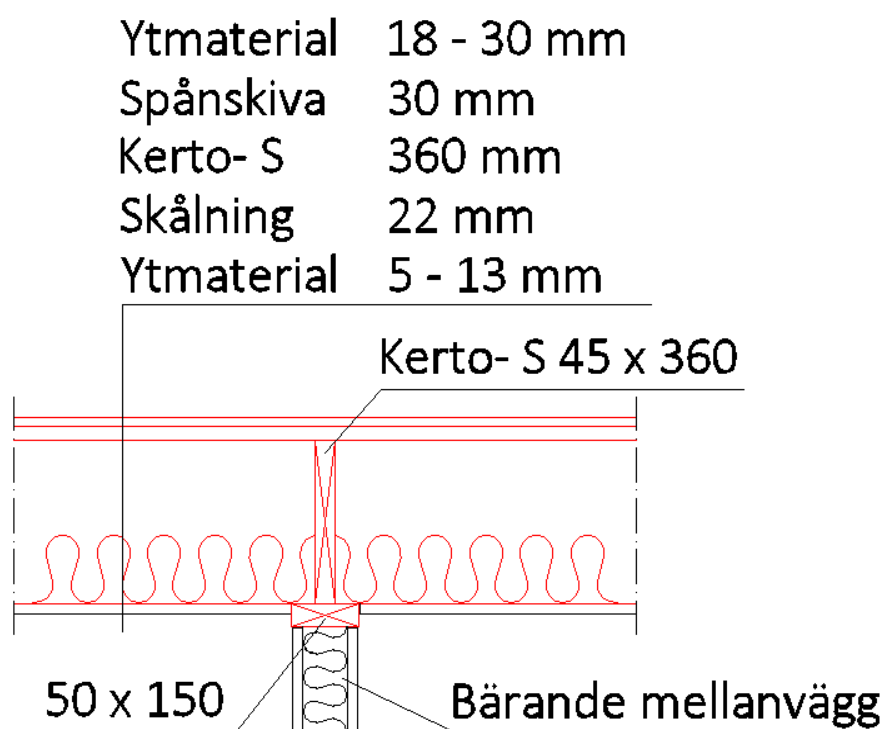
Mellanbjälklaget, där positionen på väggarna som belastar mellanbjälklaget är inritade.
